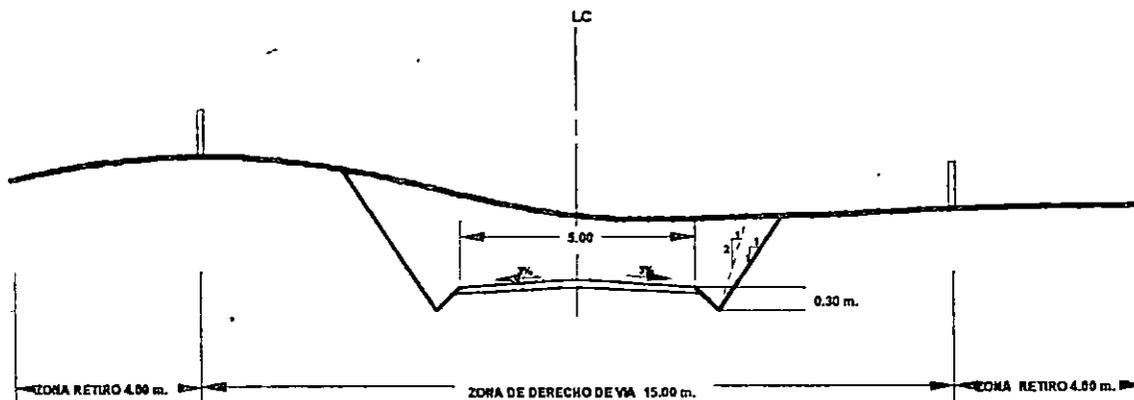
SECCION TIPICA DE CORTE EN TANGENTE
